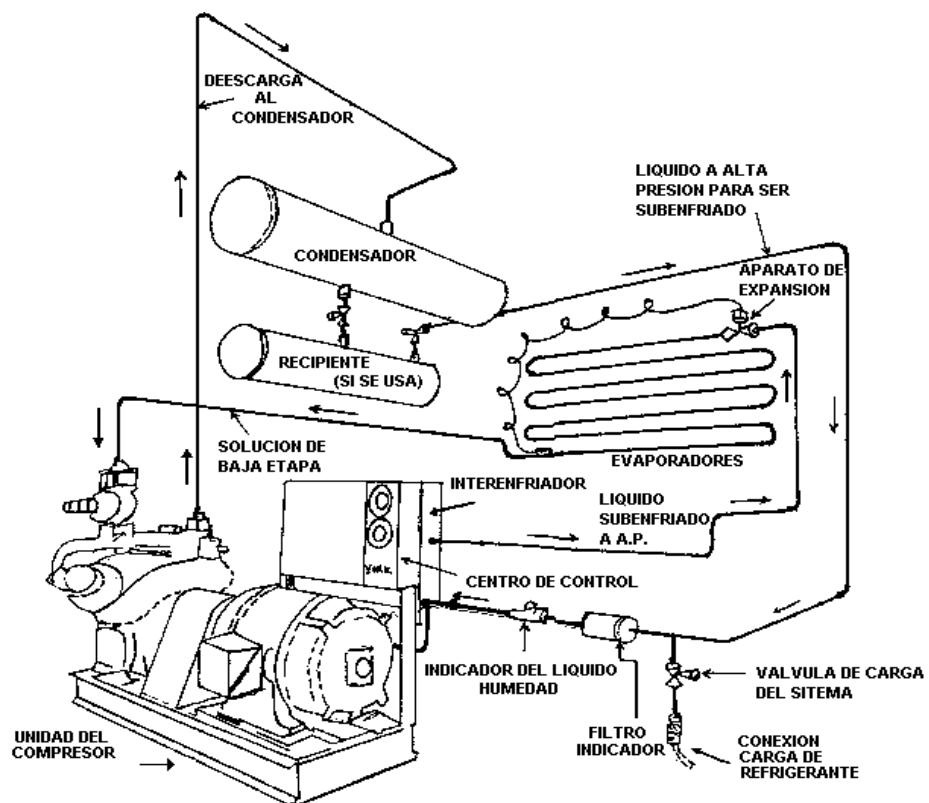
Dibujo Técnico del Sistema Refrigerante del Acondicionador de Aire
